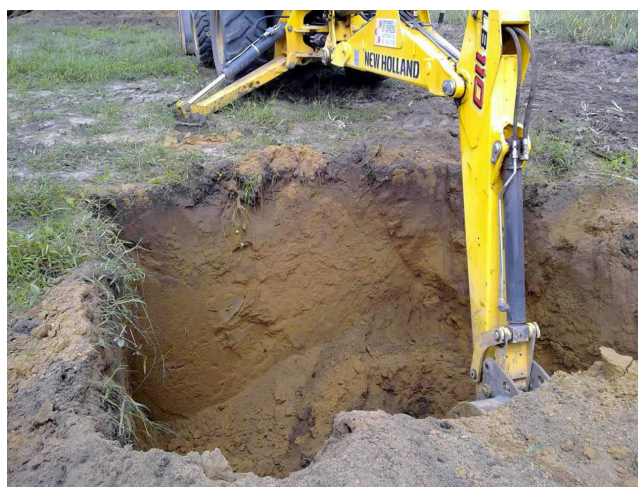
Retroescavadeira realizando escavações da estrutura 8/1.
